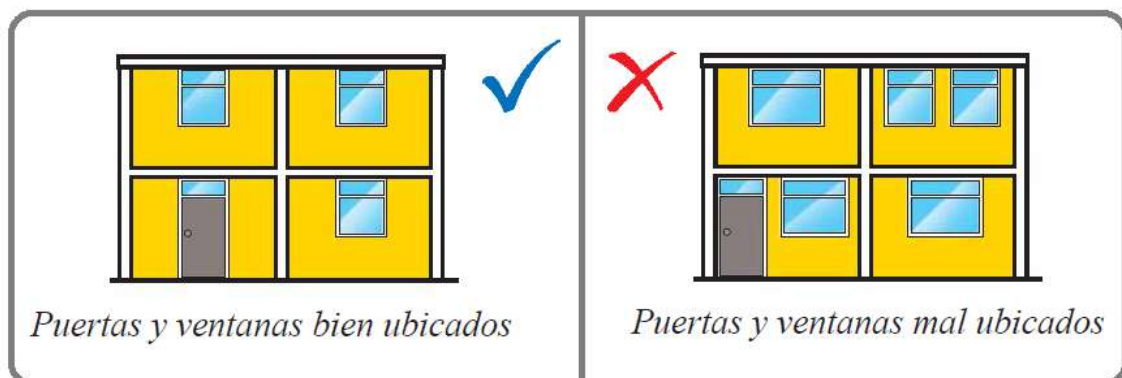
Ubicación de la adecuada colocación de puertas y ventanas.
